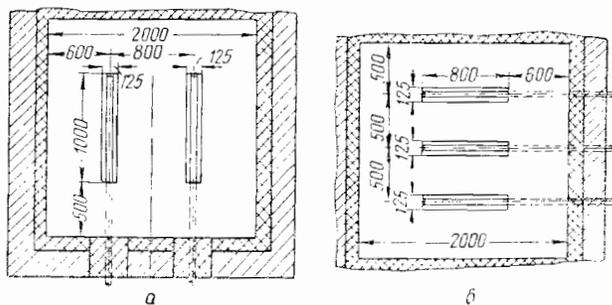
15. Схемы размещения подовых горелок в топках котлов (план).
